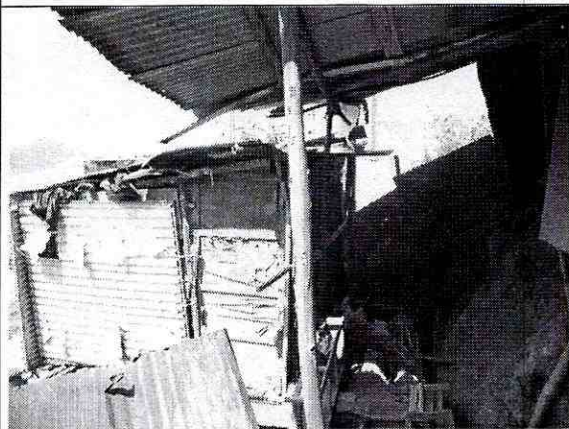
Láminas metálicas y madera del cerramiento del segundo nivel
